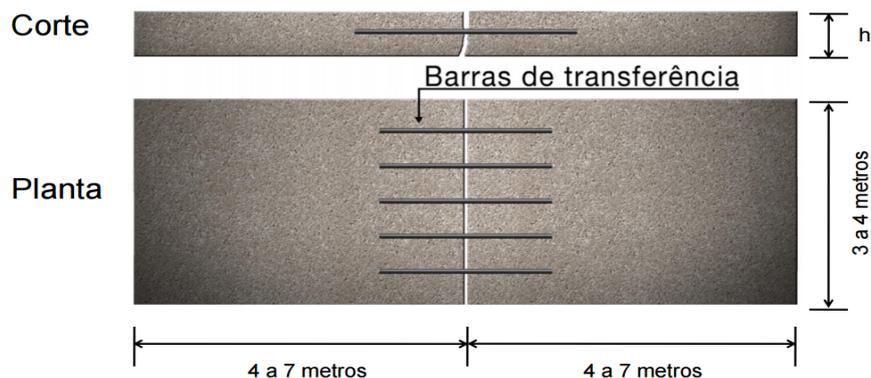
Pavimentos de concreto simples com barra de transferência
